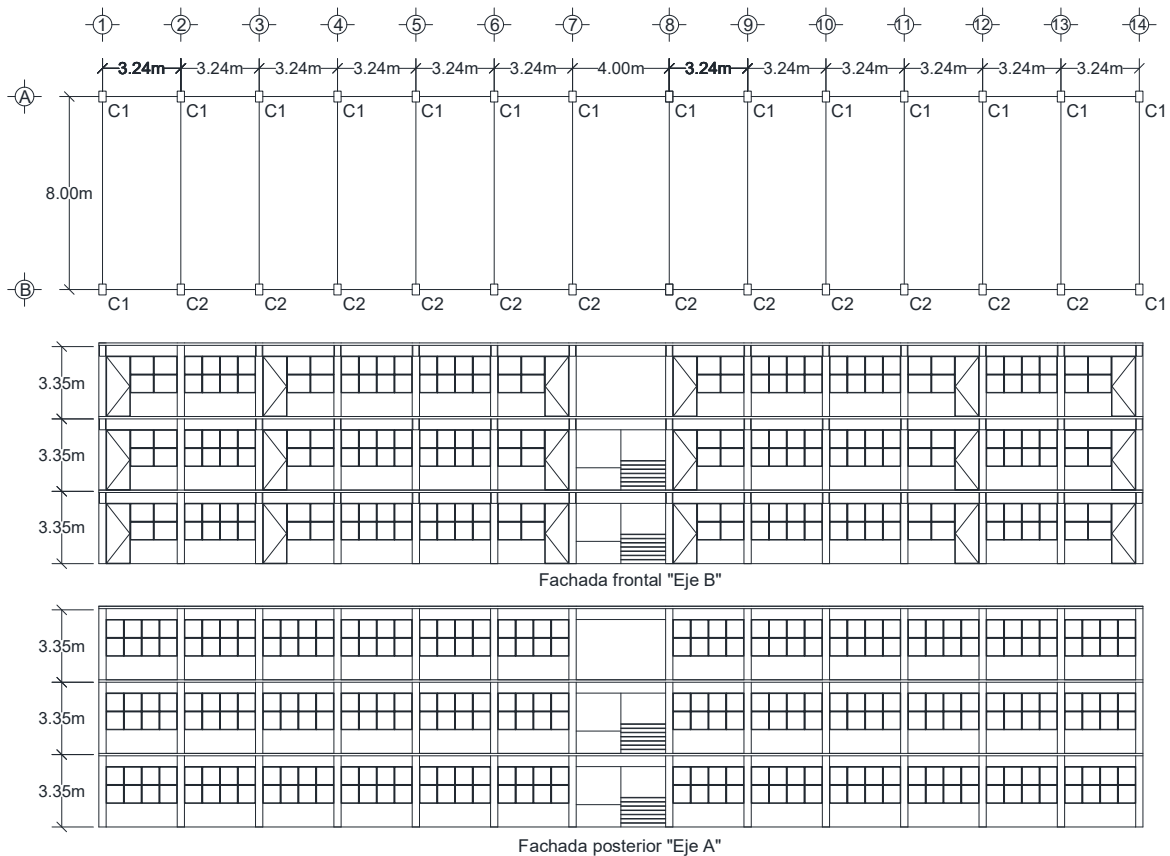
Distribución en planta y elevación del edificio escolar de tres niveles considerado en este estudio.
